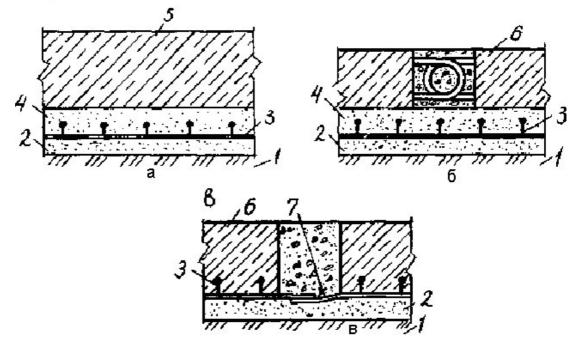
Узлы гидроизоляции из полимерного листа: а — монолитные конструкции; б,в — сборные элементы; 1 — уплотненное основание; 2 — песчаная подушка; 3 — полимерный лист; 4 — защитная стяжка; 5 — монолитное днище; 6 — сборные плиты; 7 — сварной шов
